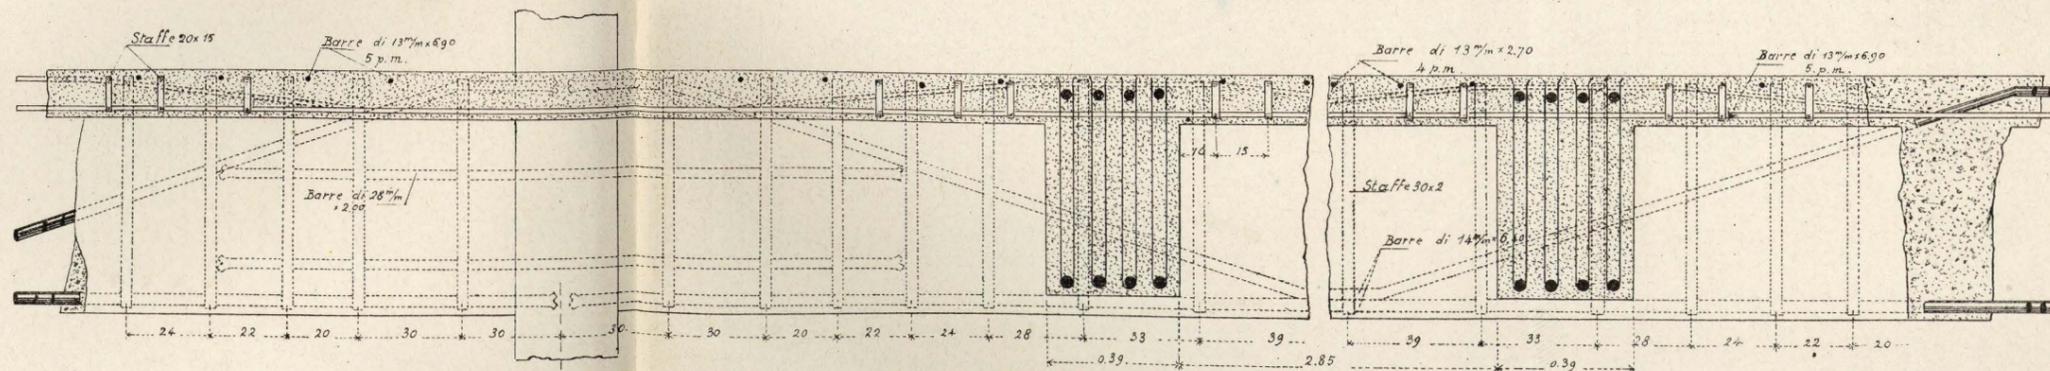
Solaio della galleria S: sezione longitudinale secondo g h.
